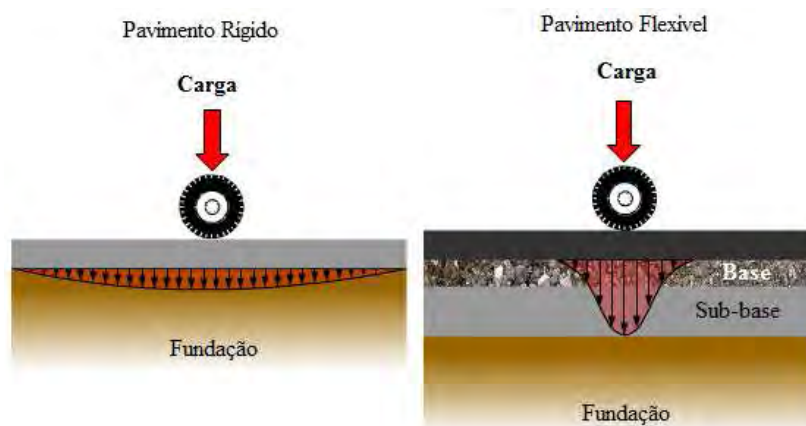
Distribuição das tensões num pavimento rígido e num pavimento flexível (PTC 2005)
